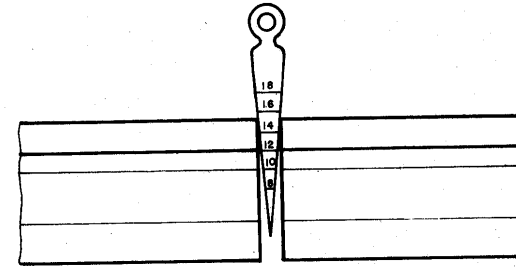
Medida de la separación entre extremos de carriles a soldar.
